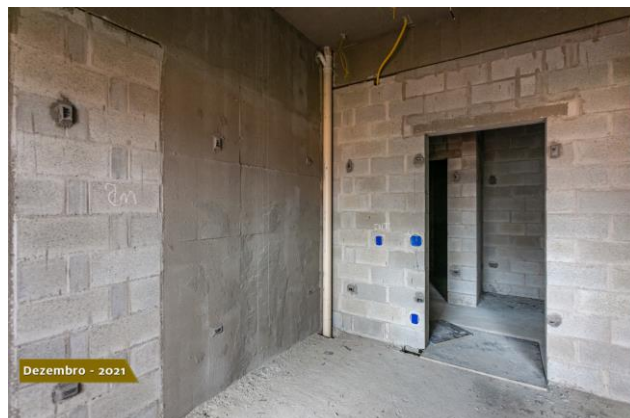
Alvenaria em pavimento finalizada com detalhe para tubulação hidráulica
